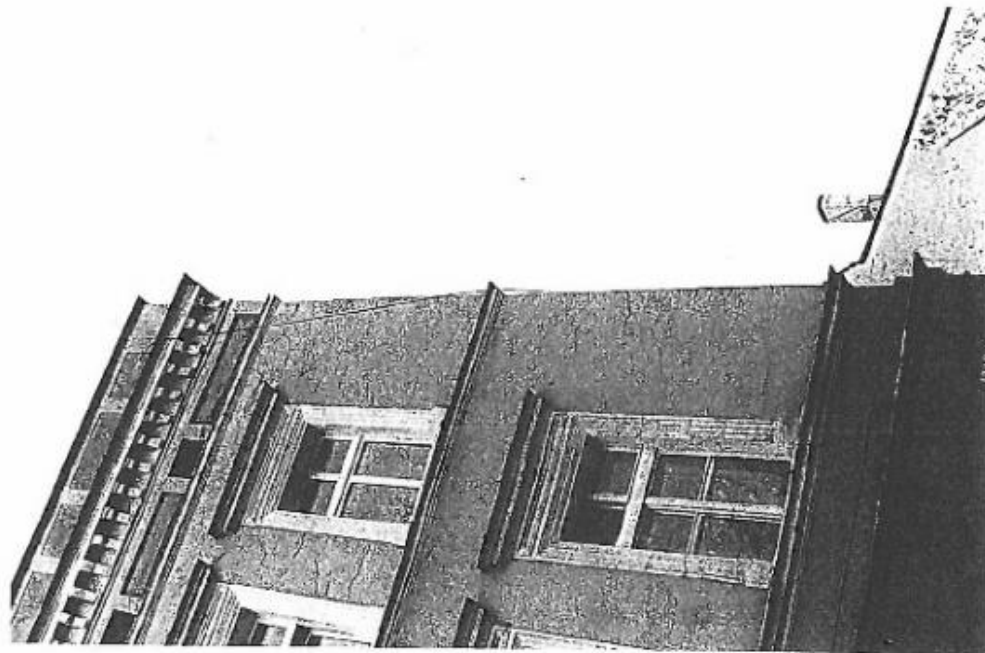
/10. Kamienica Rynek 1, elewacja wschodnia (widok od południowego-wschodu).
